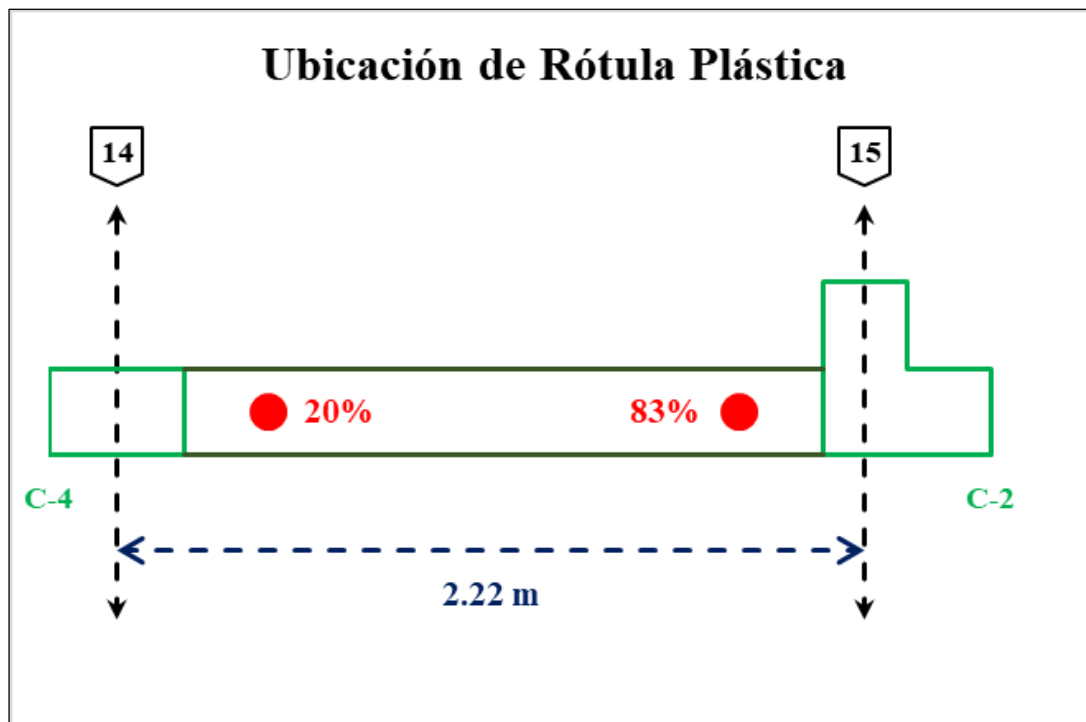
Ejemplo de la disposición de rotulas plásticas en vigas
